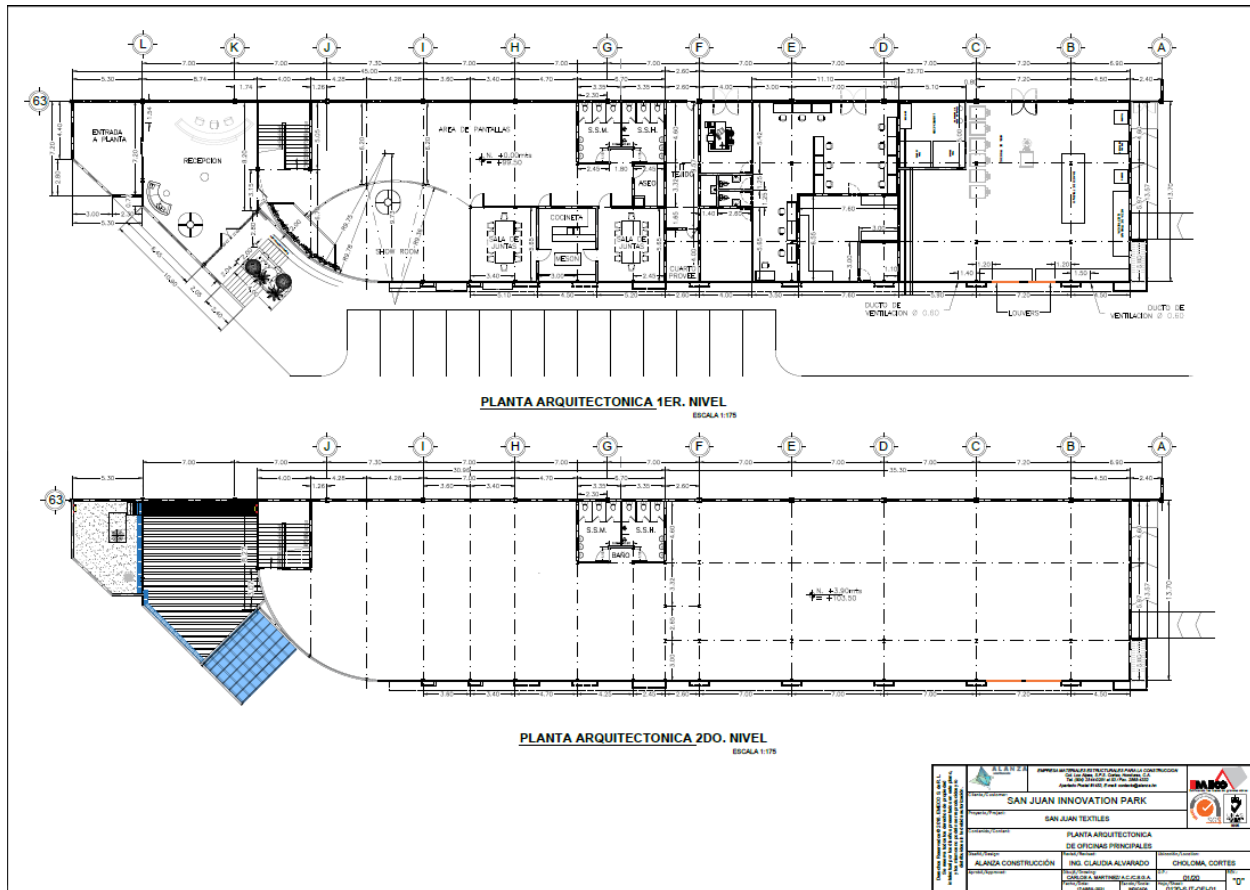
Plano de planta arquitectónica de Oficinas Principales
